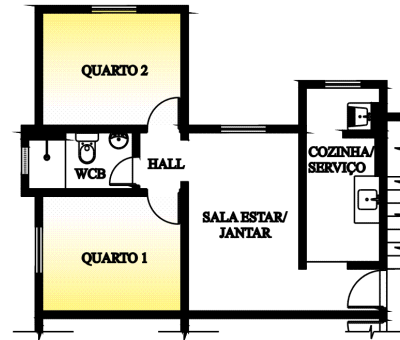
Planta Baixa Pav. Tipo do Residencial Luiz dos Anjos (sem escala)
